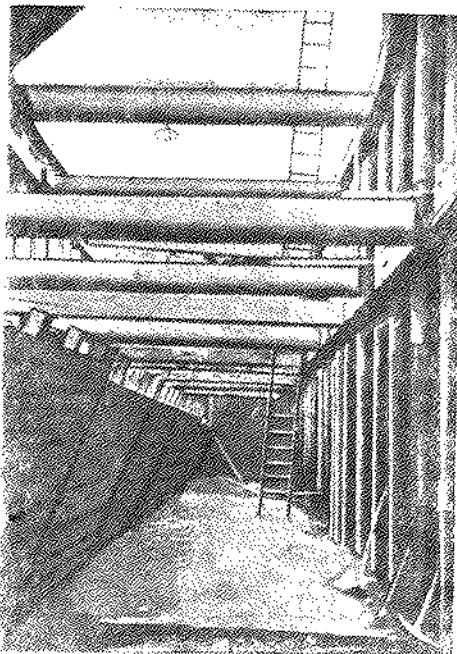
Общий вид осущенного котлована под набережную после укладки подводного бетона.
